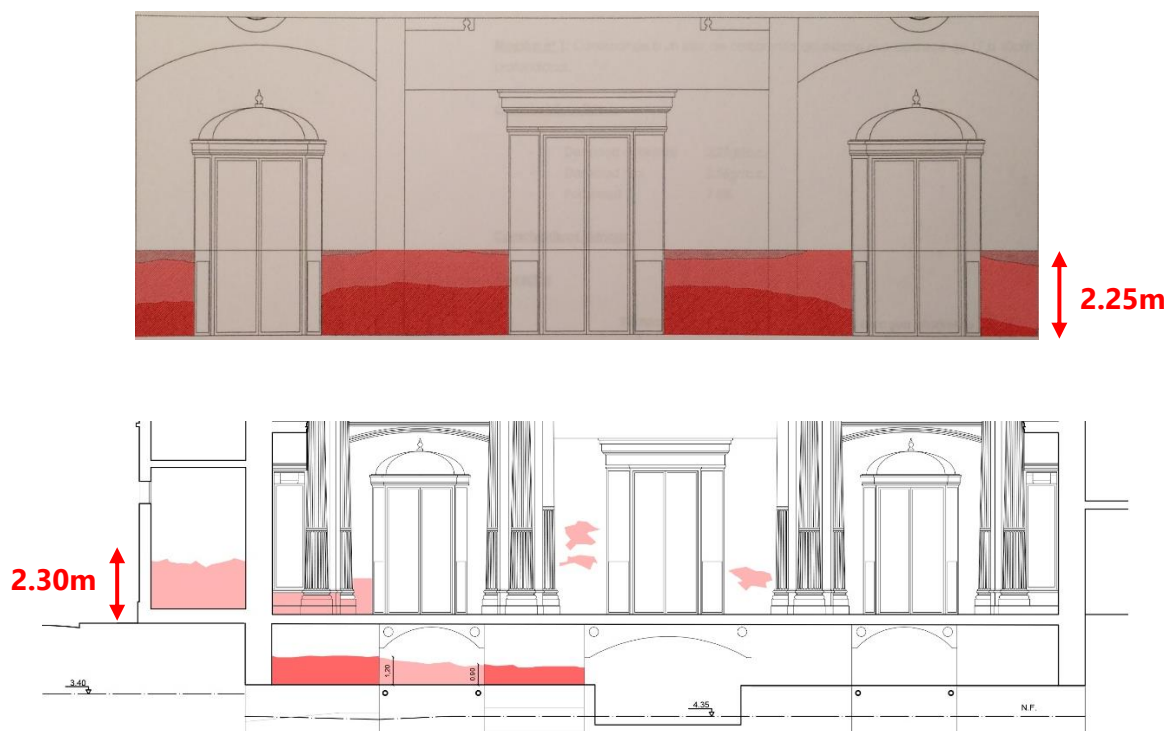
Alzado interior. Fachada Principal Humedades. Vorsevi S.A. (arriba) y Estado Actual (abajo)
